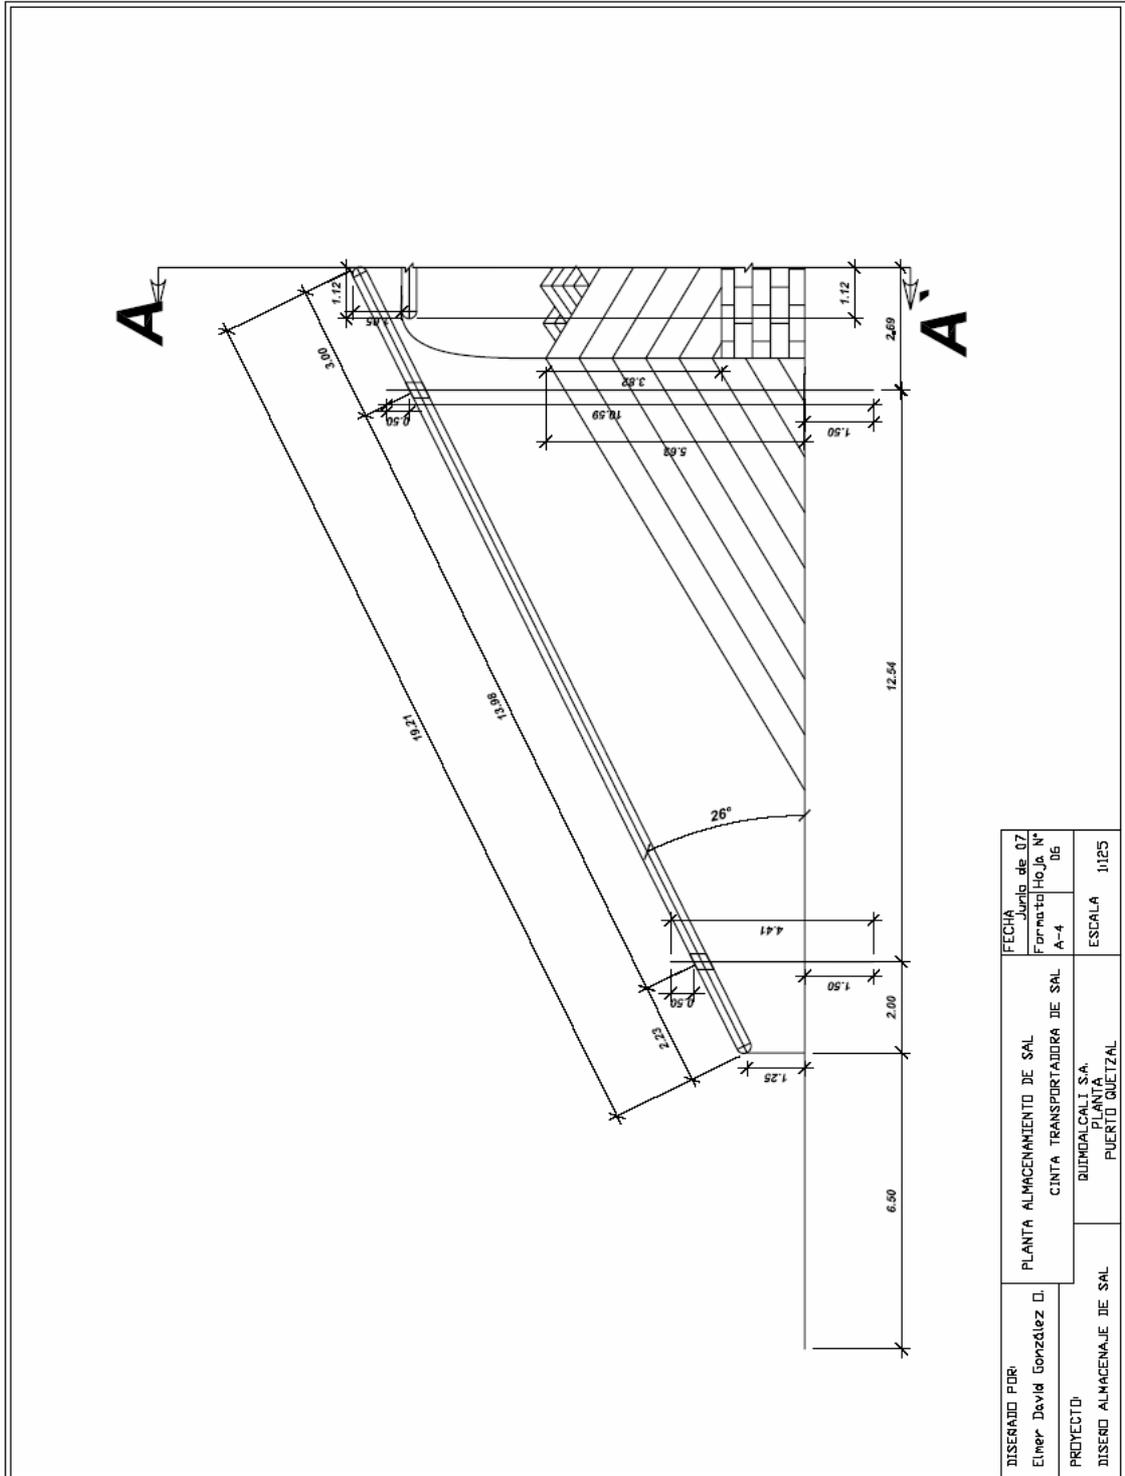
Elevación del corte de la sección de A-A' a B-B'
